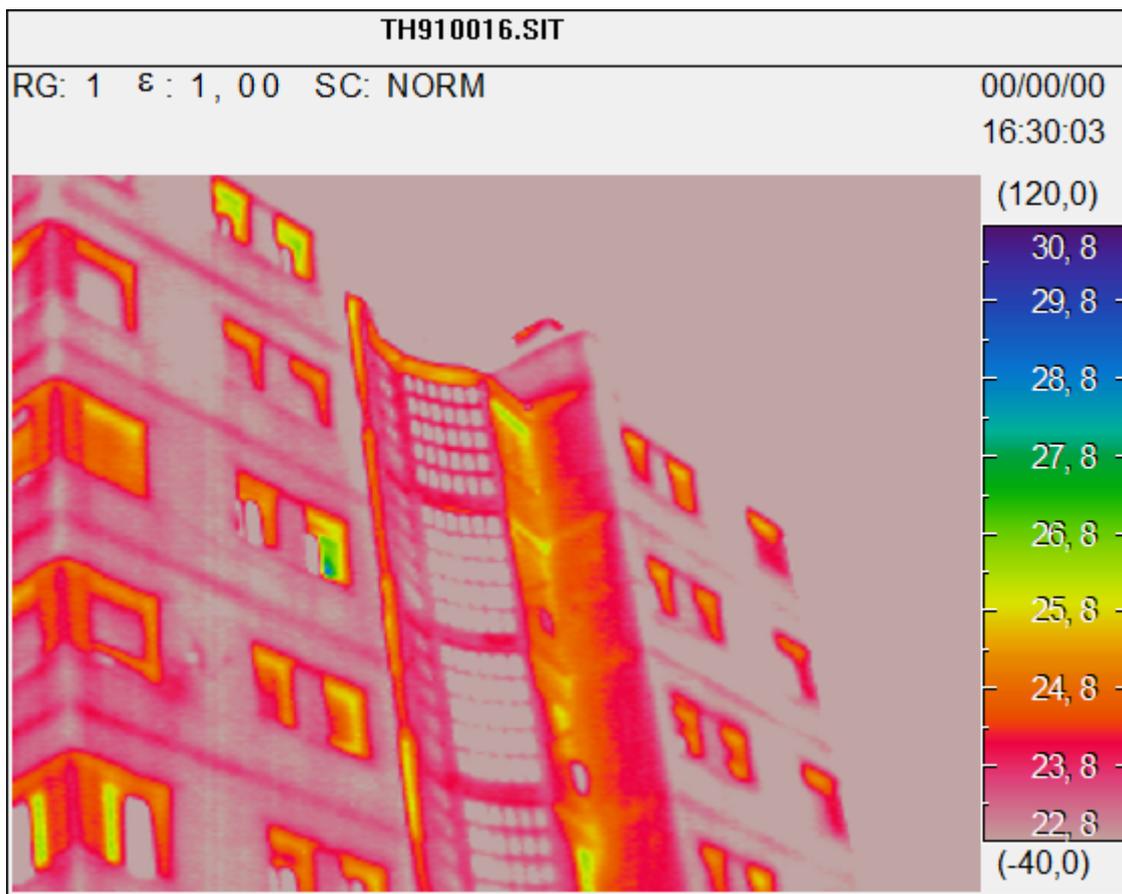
Fachada Sur 16 horas, mes de Julio.
